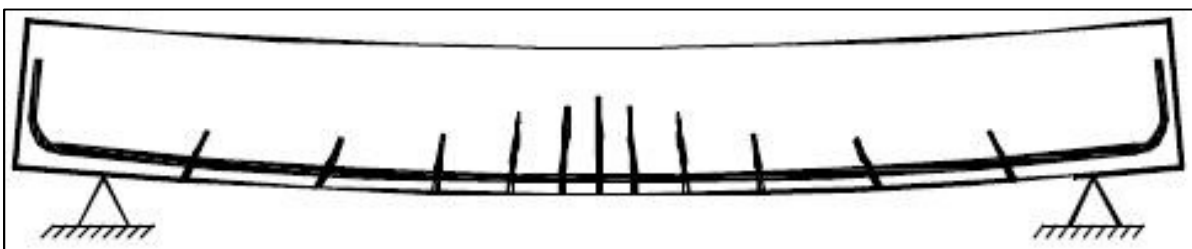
Exemplo de distribuição das fissuras em uma viga.
